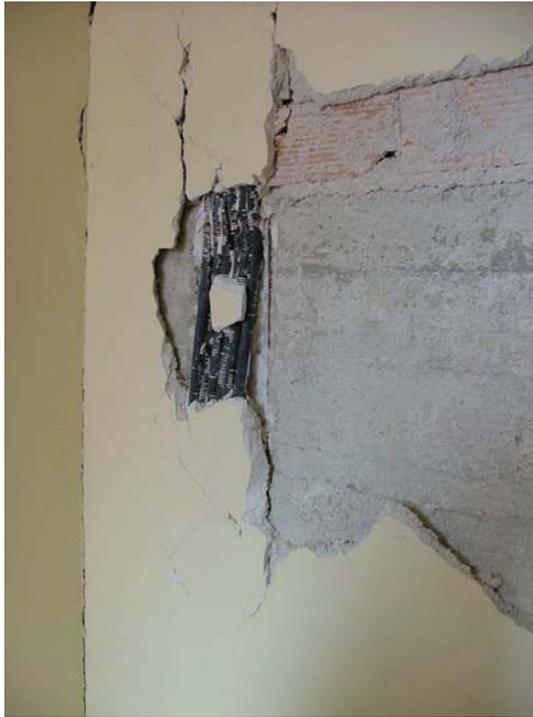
19: Riduzione della sezione resistente dei pilastri per passaggio impianto.
